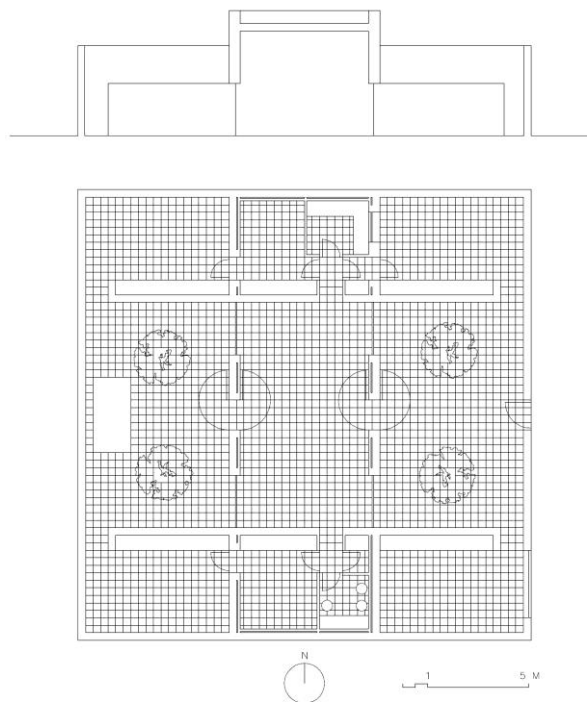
Alzado y Planta Arquitectónica Casa Gaspar
